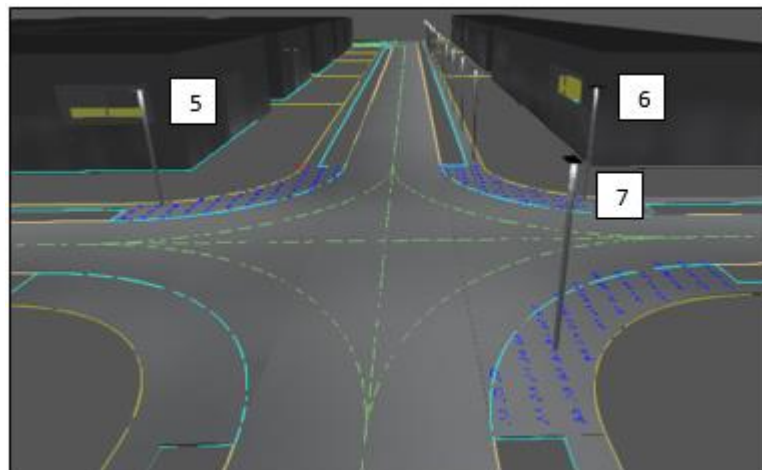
Perspectiva 3D da planta do loteamento industrial referente à luminária do tipo Akila Road (Anexo V)
